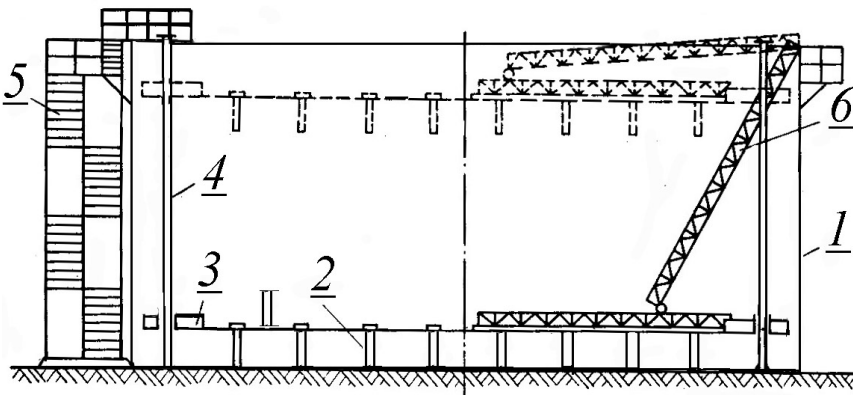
Резервуар з плаваючою покрівлею
